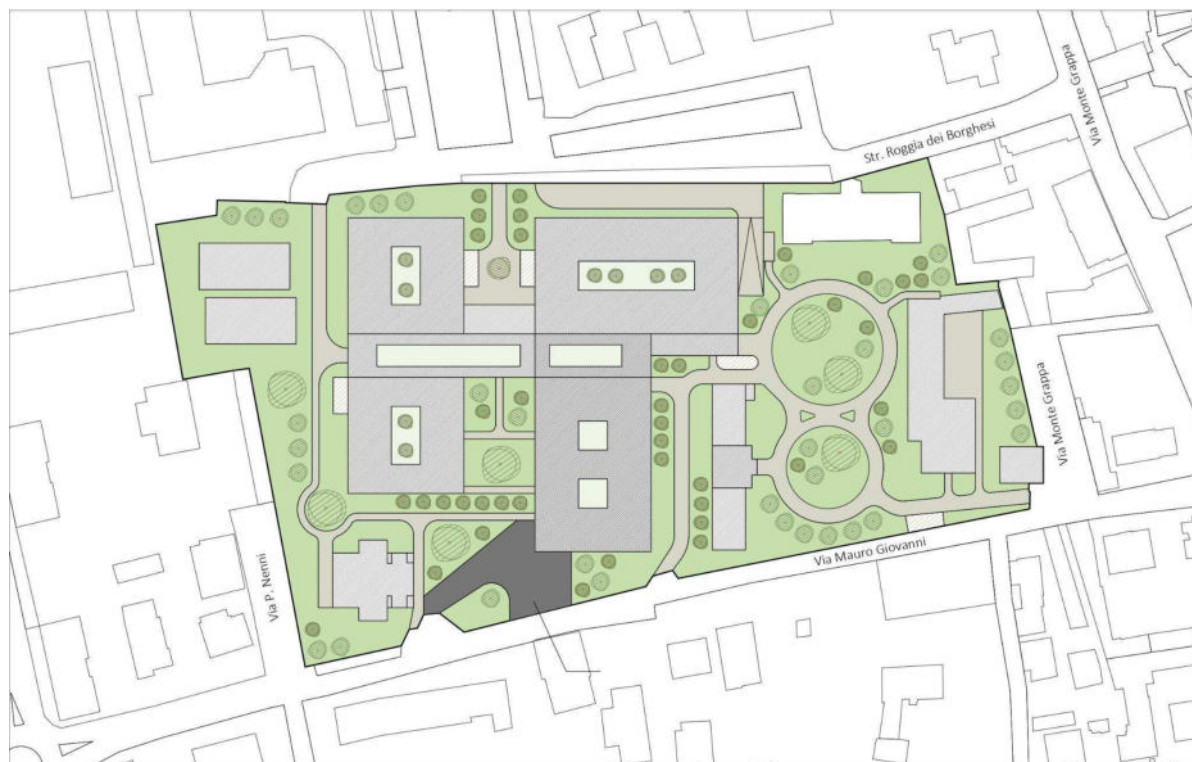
| Masterplan di progetto (TAV19 - Masterplan).
